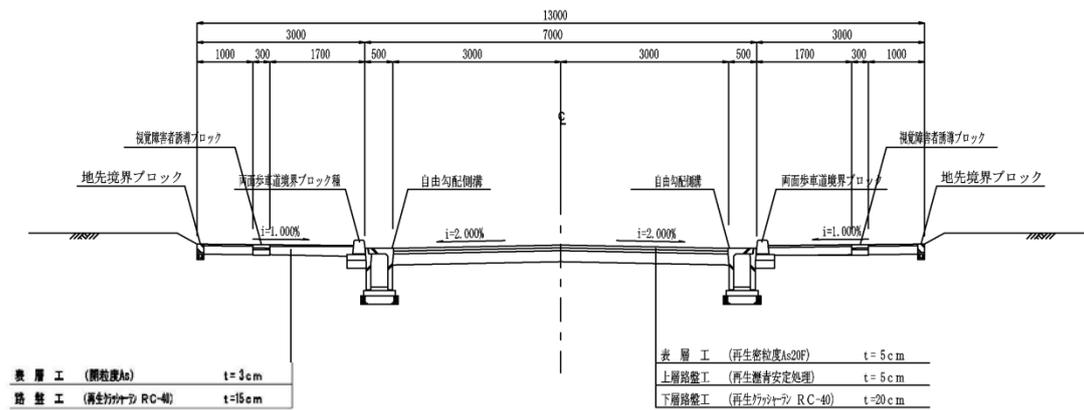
(3) 道路断面図(補助幹線道路: 13m 標準断面)
